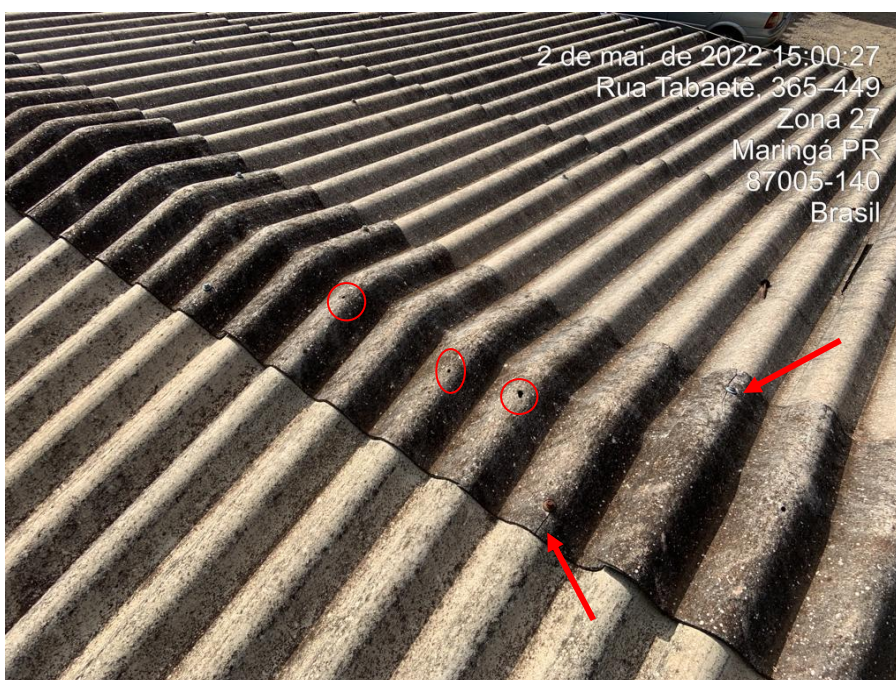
Vista parcial da cobertura sobre ampliação executada em 2015, destacando perfurações em cumeeira, ausência de fixação (parafuso) e trincas.
